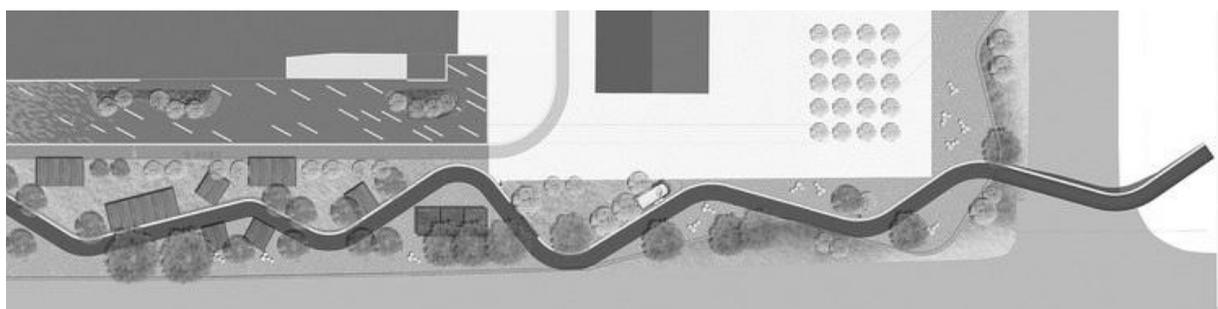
Схема генплана. Реконструкция набережной Минханг / SPARK Architects
